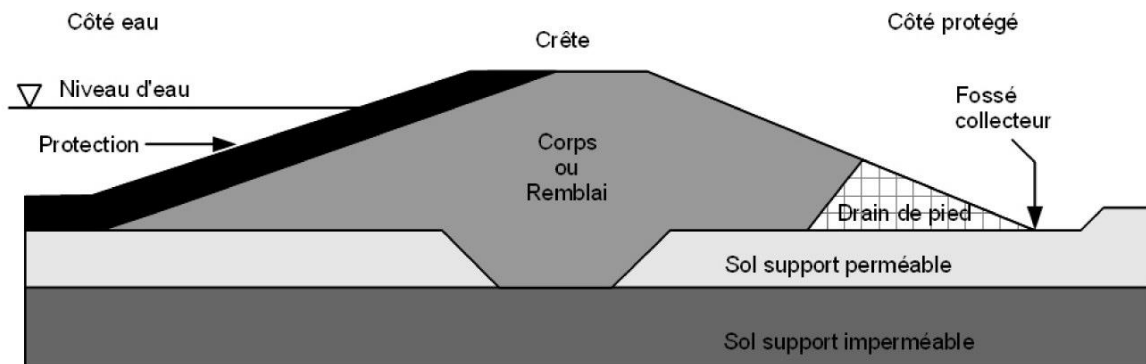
Digue homogène sur fondation perméable avec ancrage d'étanchéité
